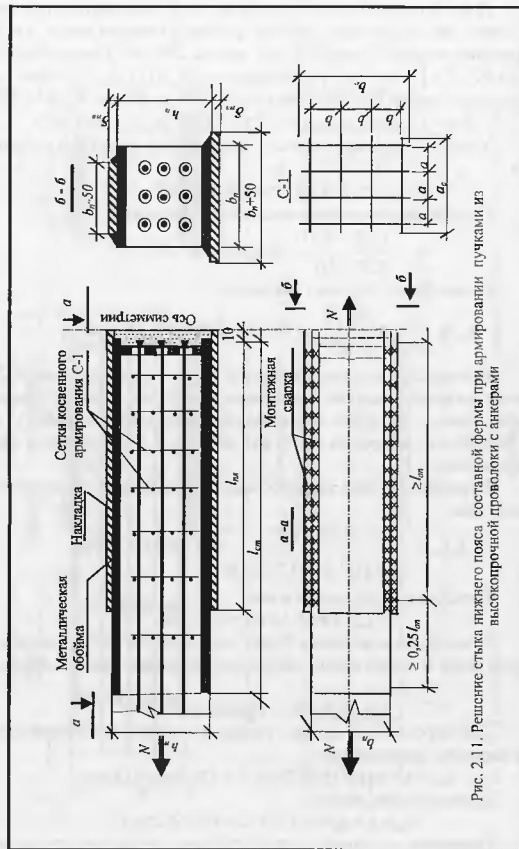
Решение стыка нижнего пояса составной фермы при армировании пучками из высокопрочной проволоки с анкерами
